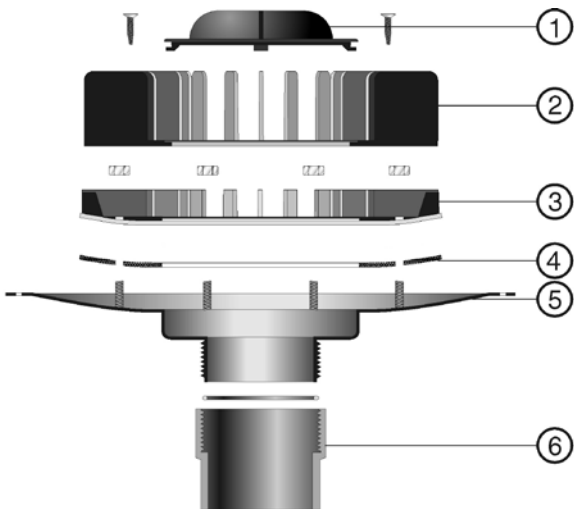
Střešní vtok QS 75 – žlabový typ – příklad uložení
